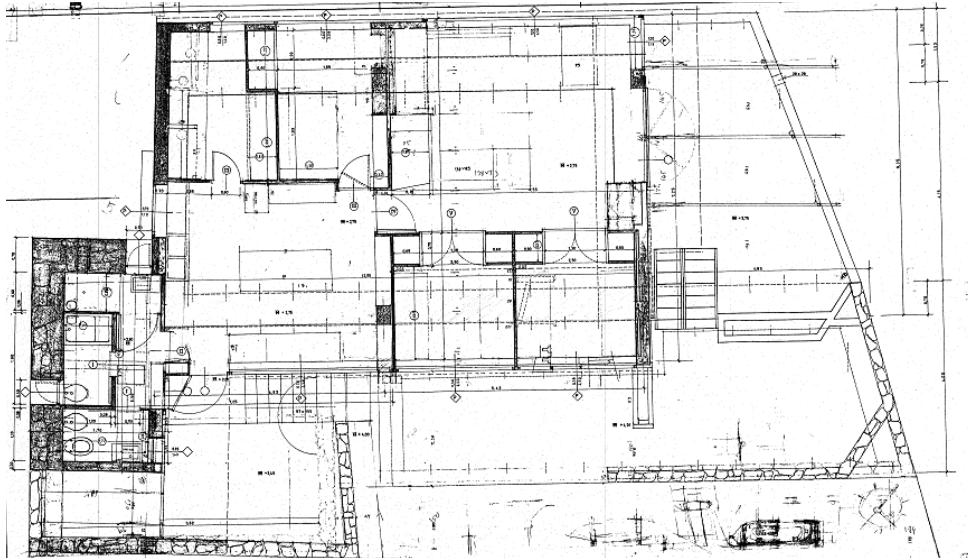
Plano de Situación de La Roiba. 1.967 Archivo Molezún
